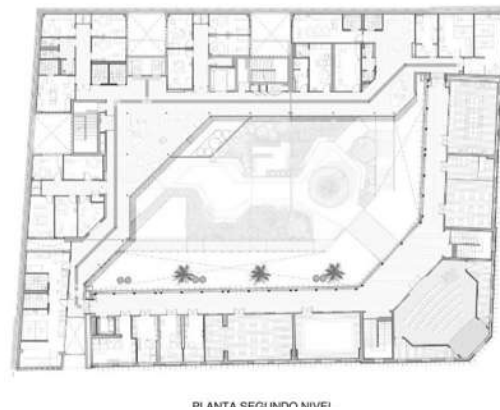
Planta del segundo nivel del centro comunitario de salud Mata Sur. Fuente: Archdaily
